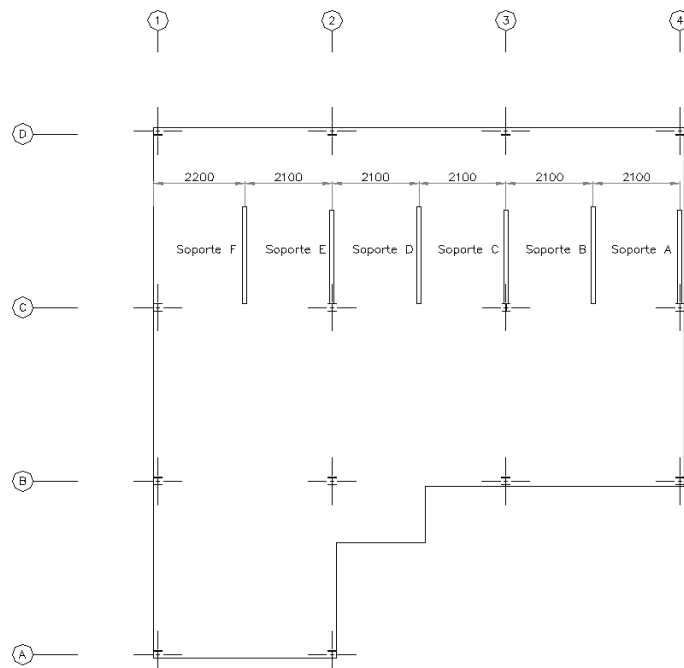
Posición de soporte de tubería en el nivel 6000.
